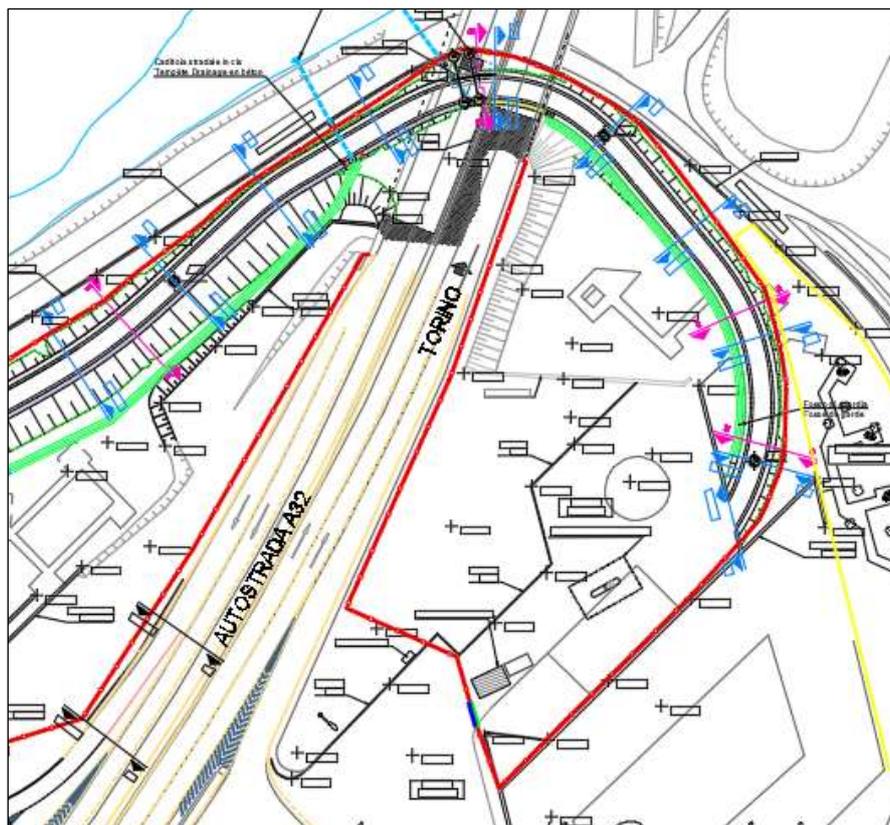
Viabilità di entrata in A32 dal Cantiere secondo il Progetto Esecutivo
